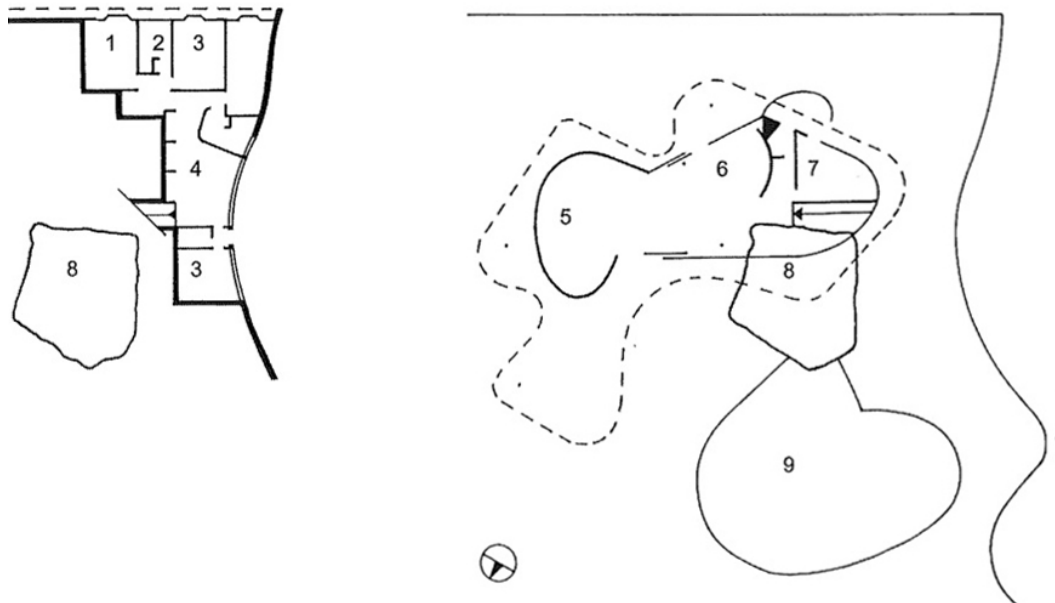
Oscar Niemeyer, Grundrisspläne des Casa das Canoás, 1953, links Untergeschoss; rechts Erdgeschoss. Legende: (1) Arbeitszimmer, (2) Bad, (3) Schlafzimmer, (4) Bibliothek, (5) Wohnbereich, (6) Essbereich, (7) Küche, (8) Felsen, (9) Schwimmbaden (Werner 2003, S. 83).
